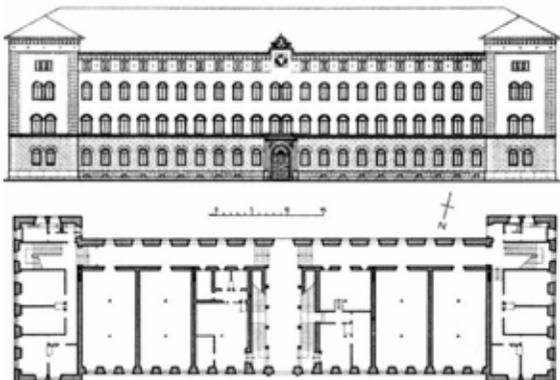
Fassade und Grundriss vom Erdgeschoss
